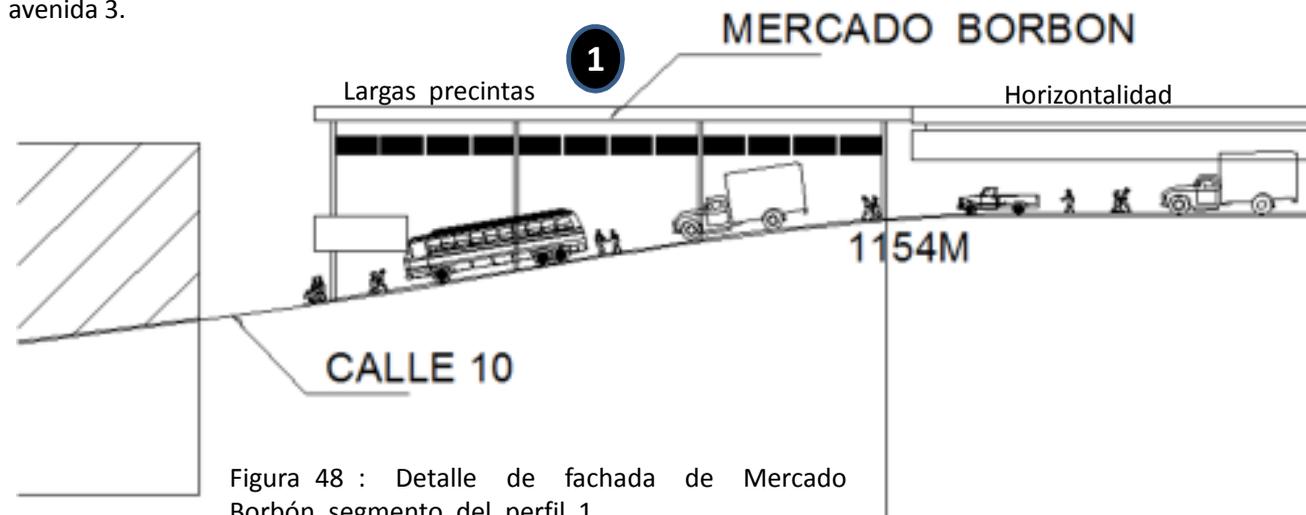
Detalle de fachada de Mercado Borbón, segmento del perfil 1.
